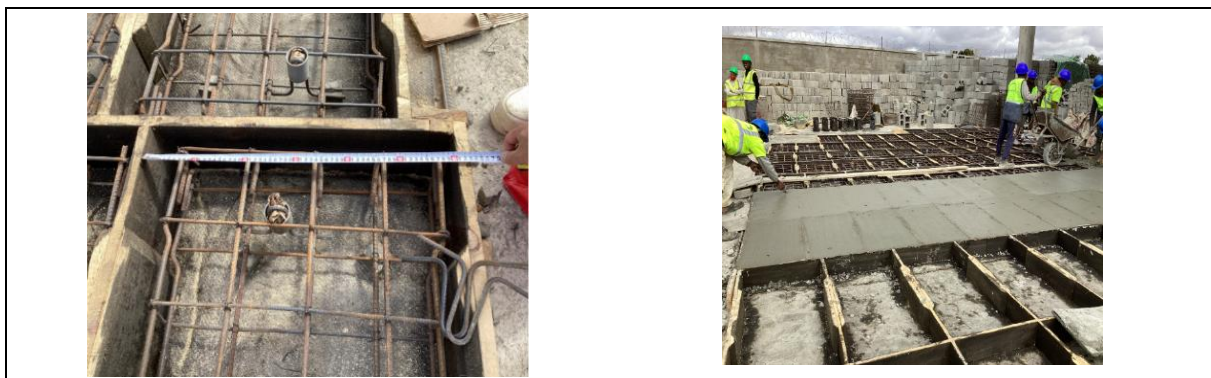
Contrôle de coffrage des dallettes / Inspection du coulage de béton
